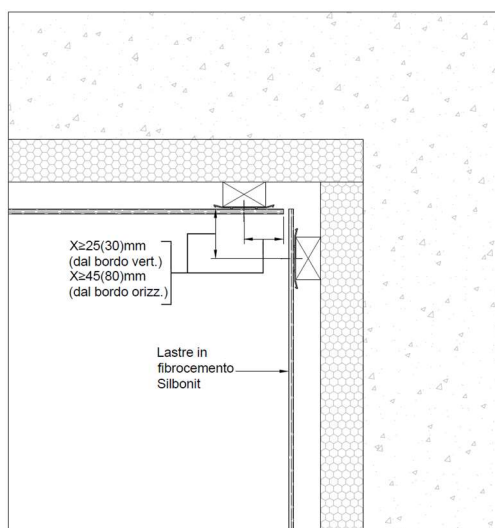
Esempio di una sezione orizzontale tipo del pacchetto di facciata ventilata in corrispondenza di un angolo interno con giunto verticale aperto tra lastre del rivestimento. Sottostruttura di legno.
